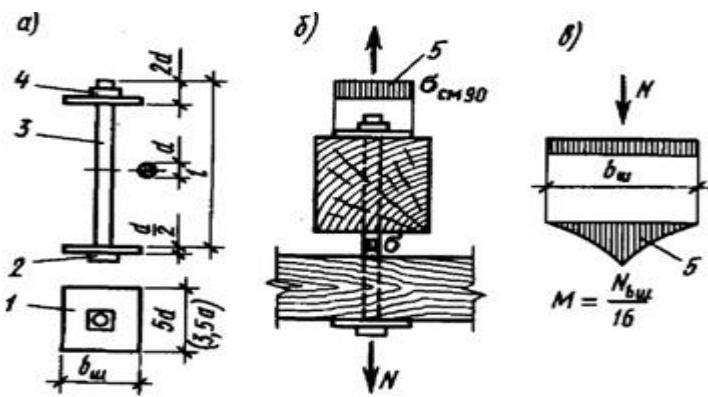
З'єднання на розтягнутих болтах: а — болт; б — схема роботи болта і деревини; г — схема роботи шайби; 1 — шайба; 2 — головка; 3 — стержень; 4 — гайка; 5 — епюри напруг
